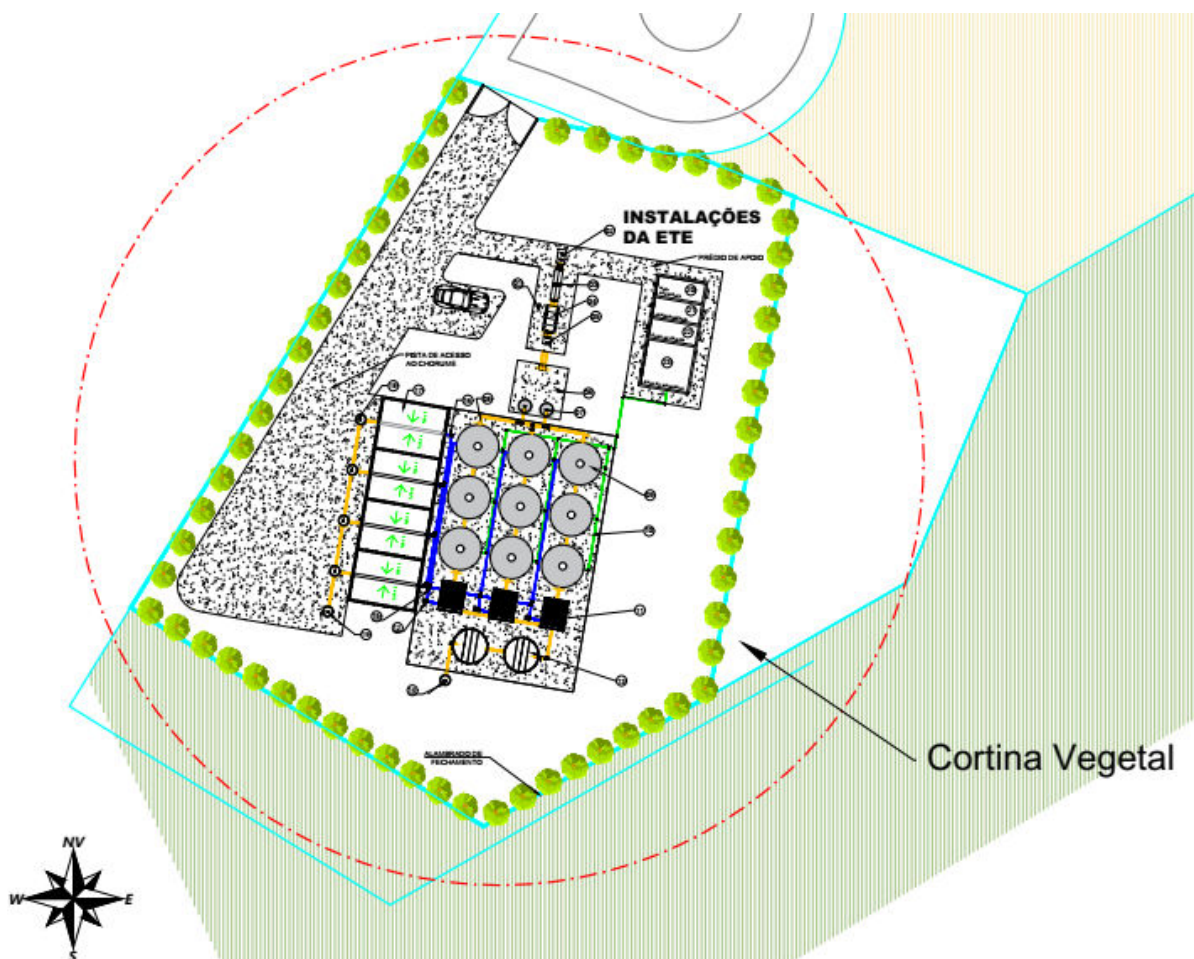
Planta Cortina Vegetal, sem escala, para ilustração.
